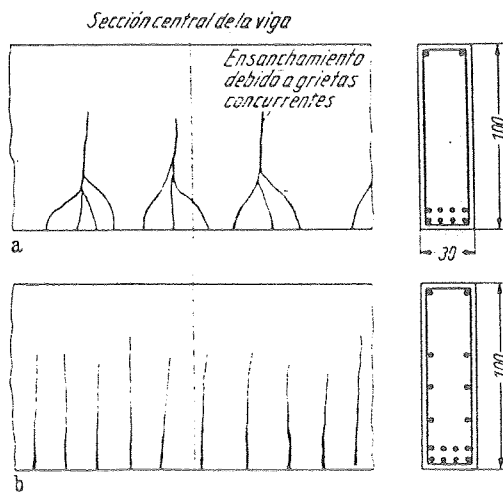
Fissuração de Vigas Altas Sem e Com Armadura de Pele (FRANZ, 1970)
